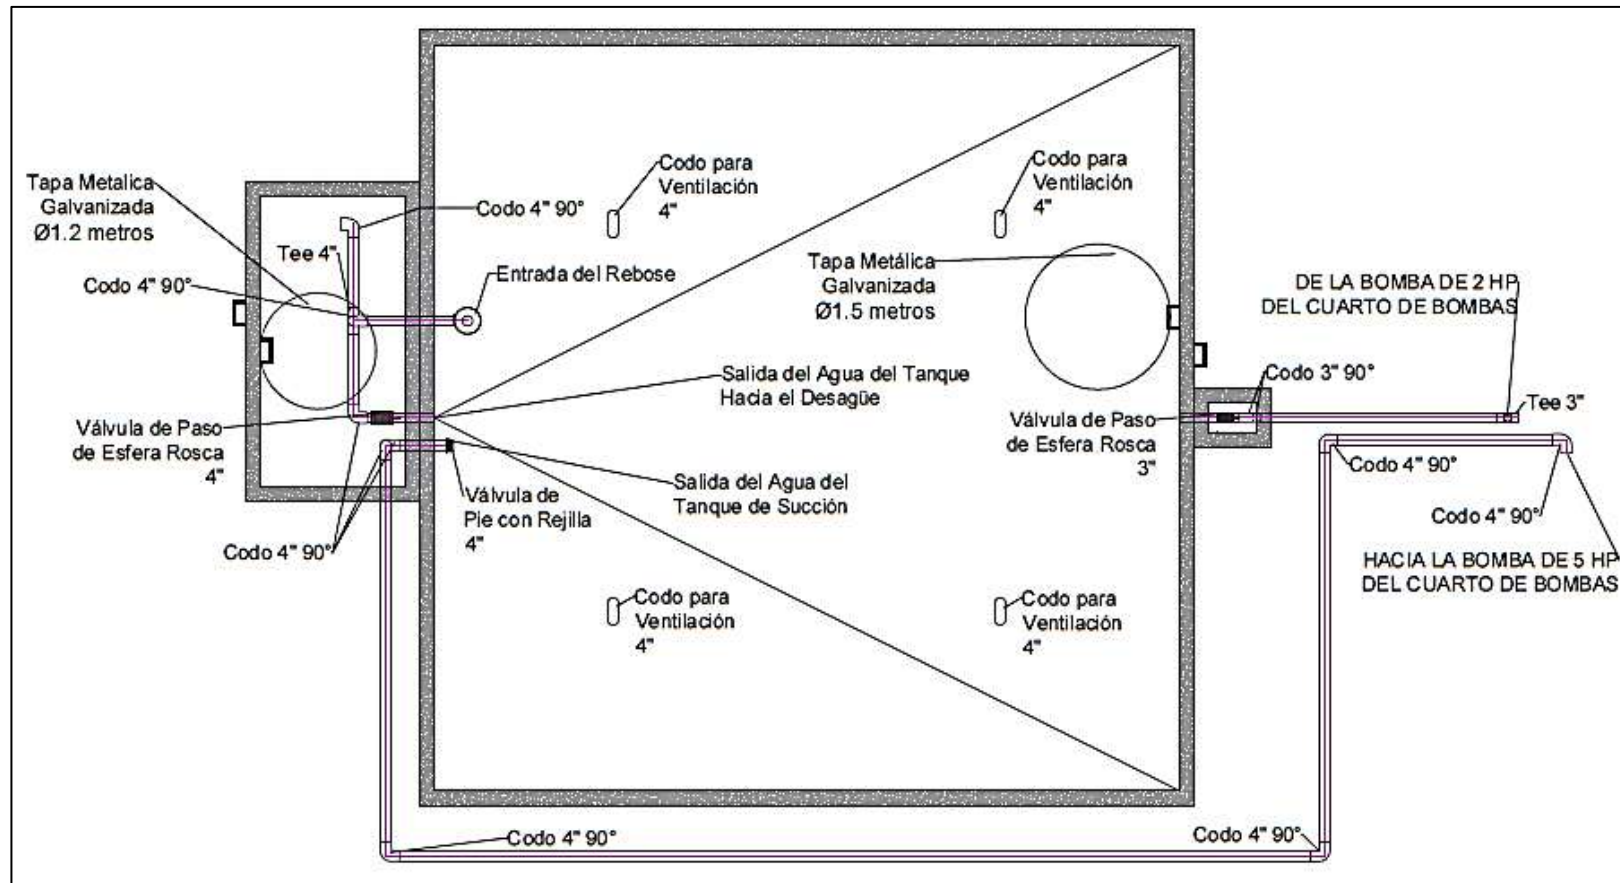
Vista en planta con accesorios hidráulicos del tanque de succión. Fuente: Elaboración propia.
